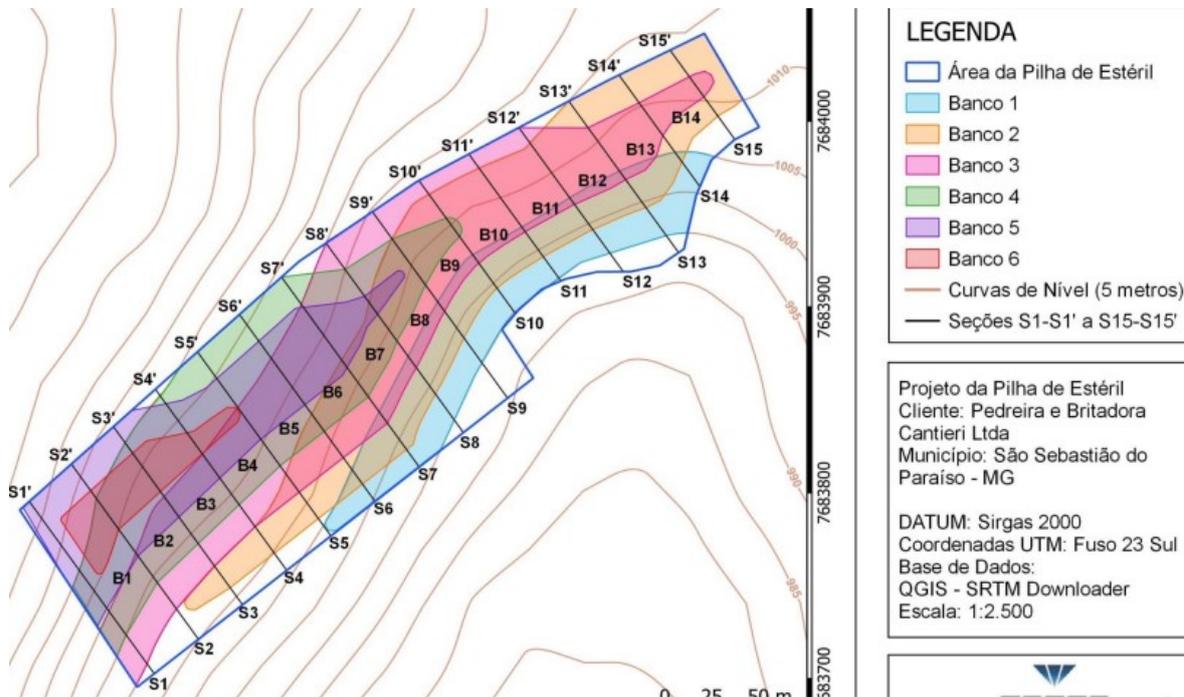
Layout por seção da pilha. Fonte identificador SLA nº 286827.
